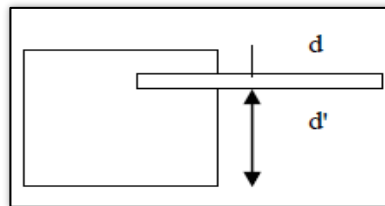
effet de l'épaisseur du béton sur acier –béton [7]
